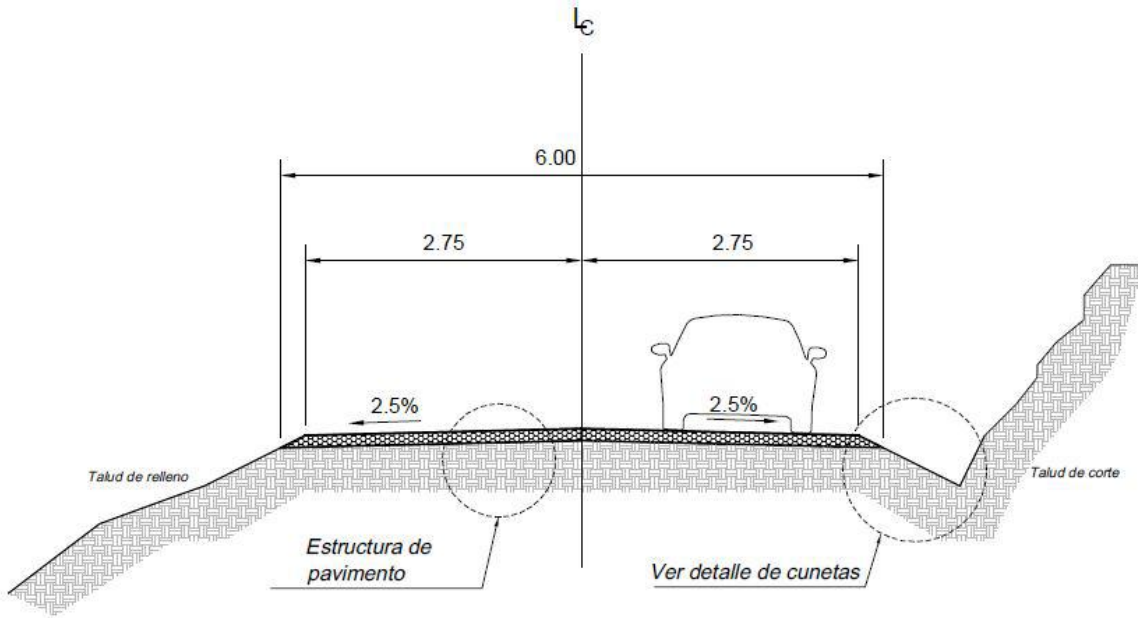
Sección Transversal Tramo 4, Est 6+000-7+987.
